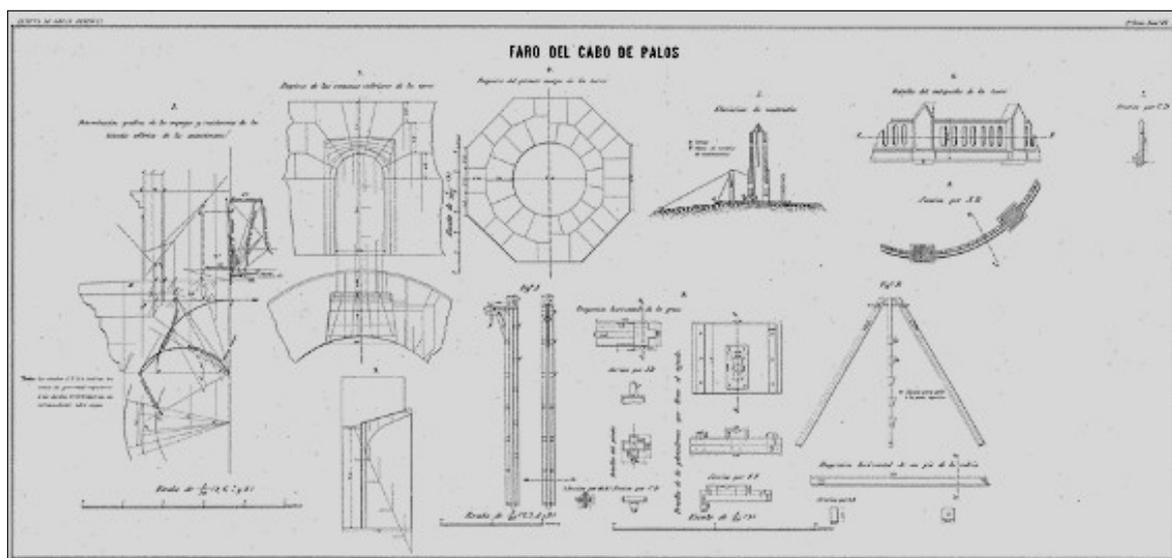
Detalles del despiece y del cálculo estructural mediante Estática Gráfica del Proyecto original de 1865 (Ref. [8]).
